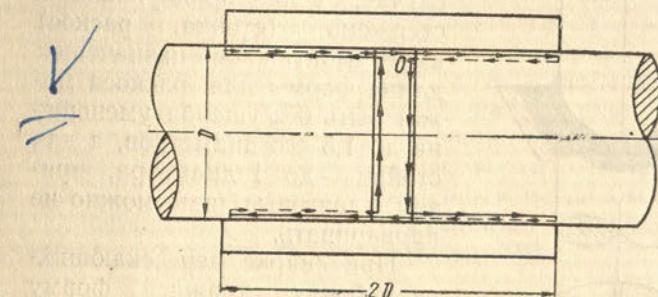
Схема движения электрода при одновременной заварке фланговых швов истыка (сварка стержней малых и средних диаметров).  $O$  — точка начала движения электрода. Сплошными линиями показано движение электрода при сварке; пунктиром — перемещение электрода по воздуху
